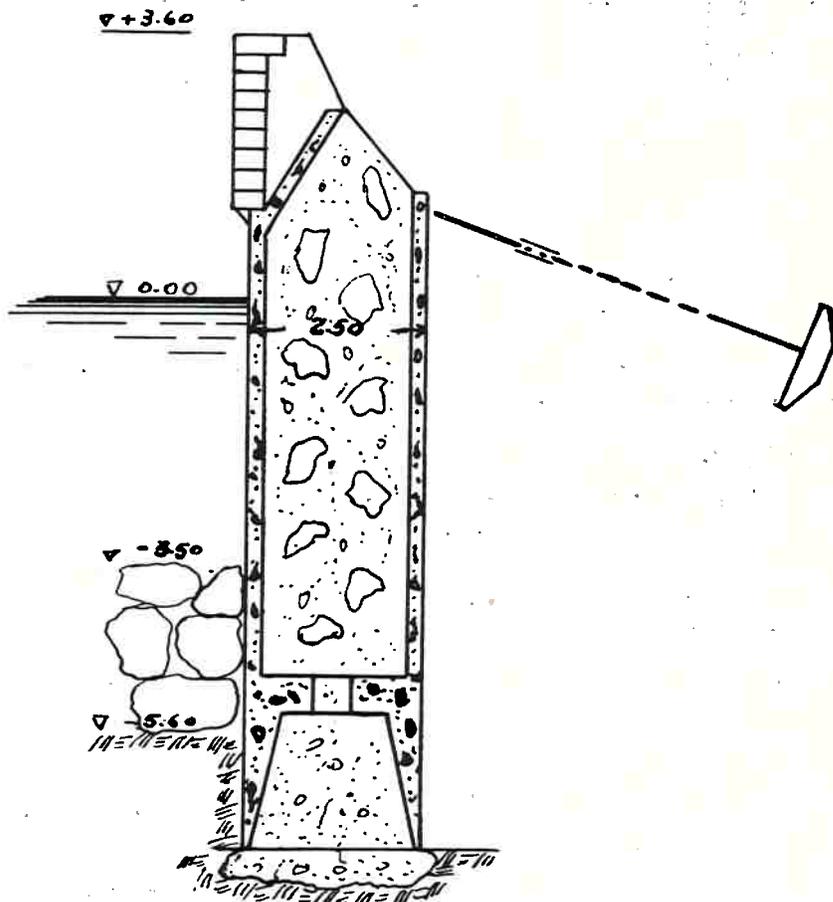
Tipo de muralha em caixões flutuantes ancorados, com 20.m00 de comprimento. (projeto não executado)
